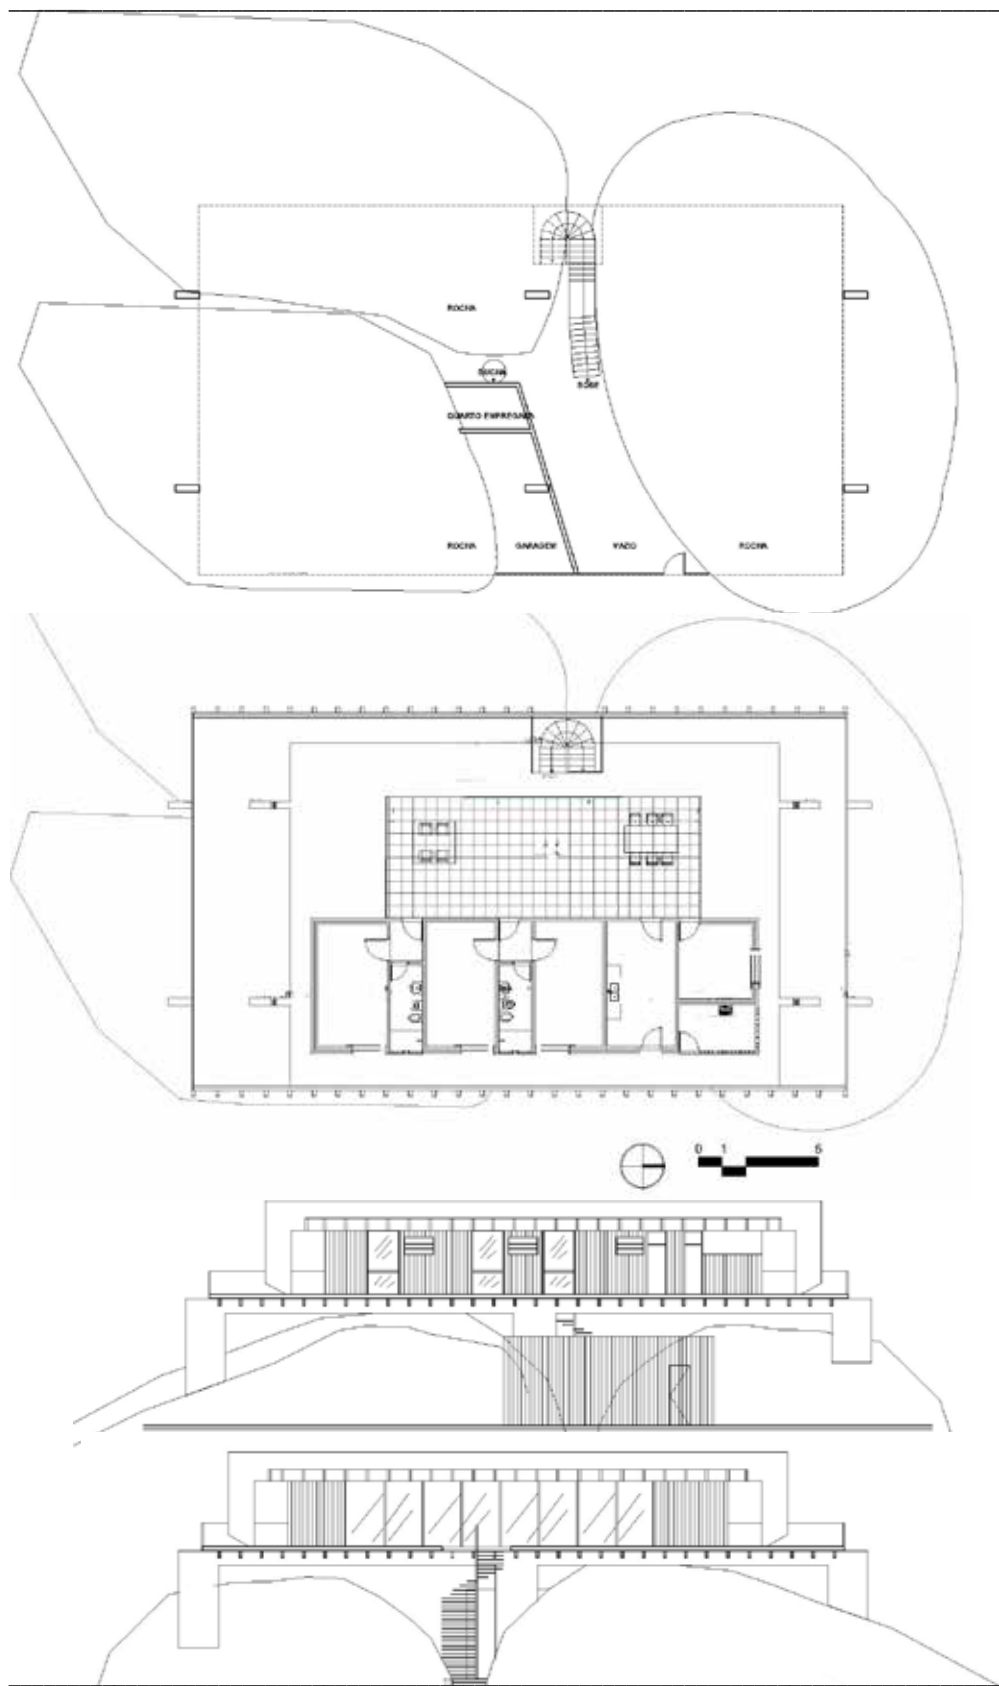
Casa Guido Weber/ Caiobá: planta pavimento térreo: acesso, garagem e escada social.
